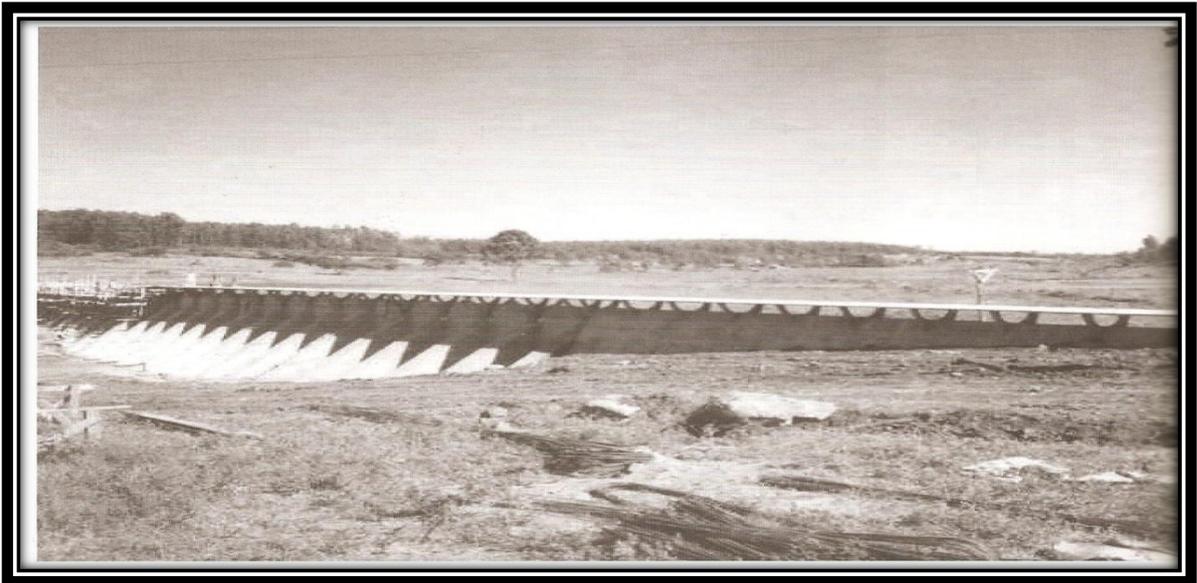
Fase de Construção da Barragem no Ribeirão Cambezinho.
